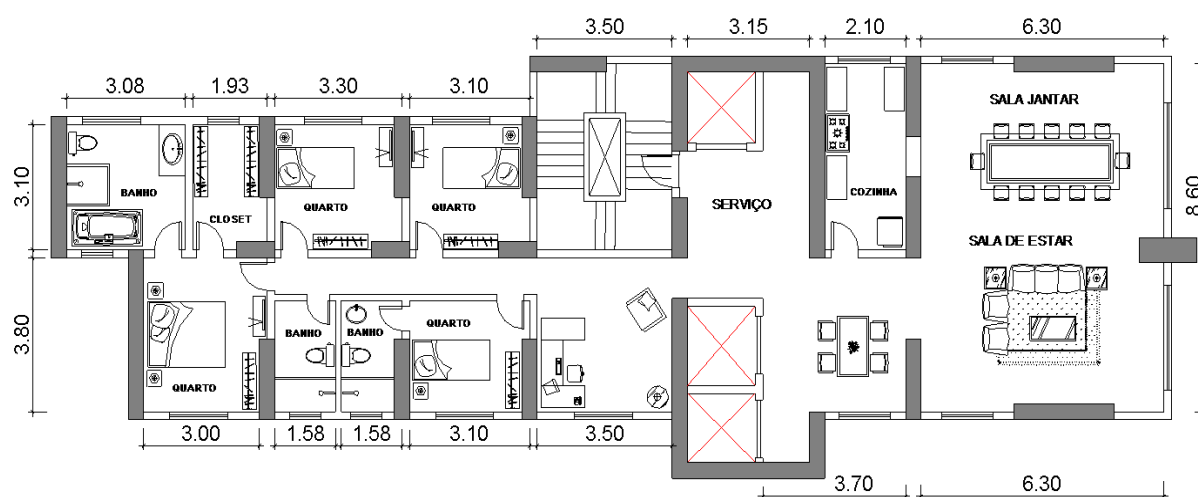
Arquitetura do Pavimento Tipo Edifício de 140 m
